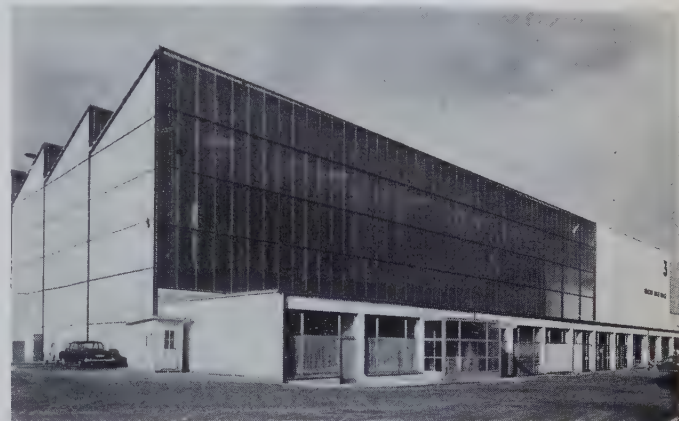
Außenansicht der Halle 3a und 3 — Walter-Kolb-Halle
